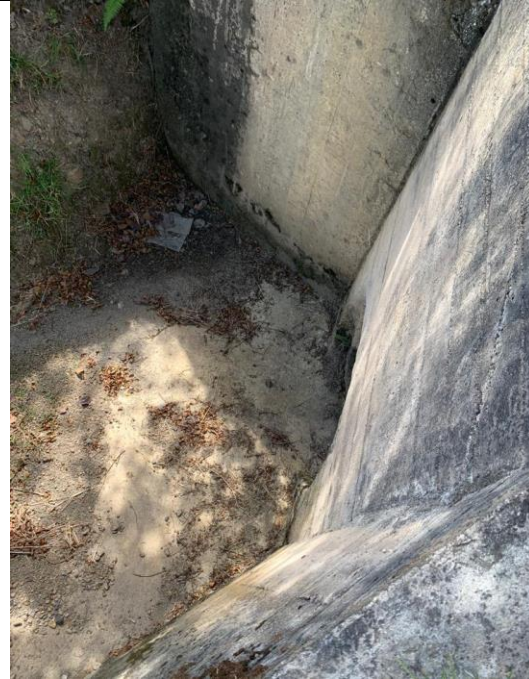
La tubería de la alcantarilla es de concreto, con diámetro de 24"
